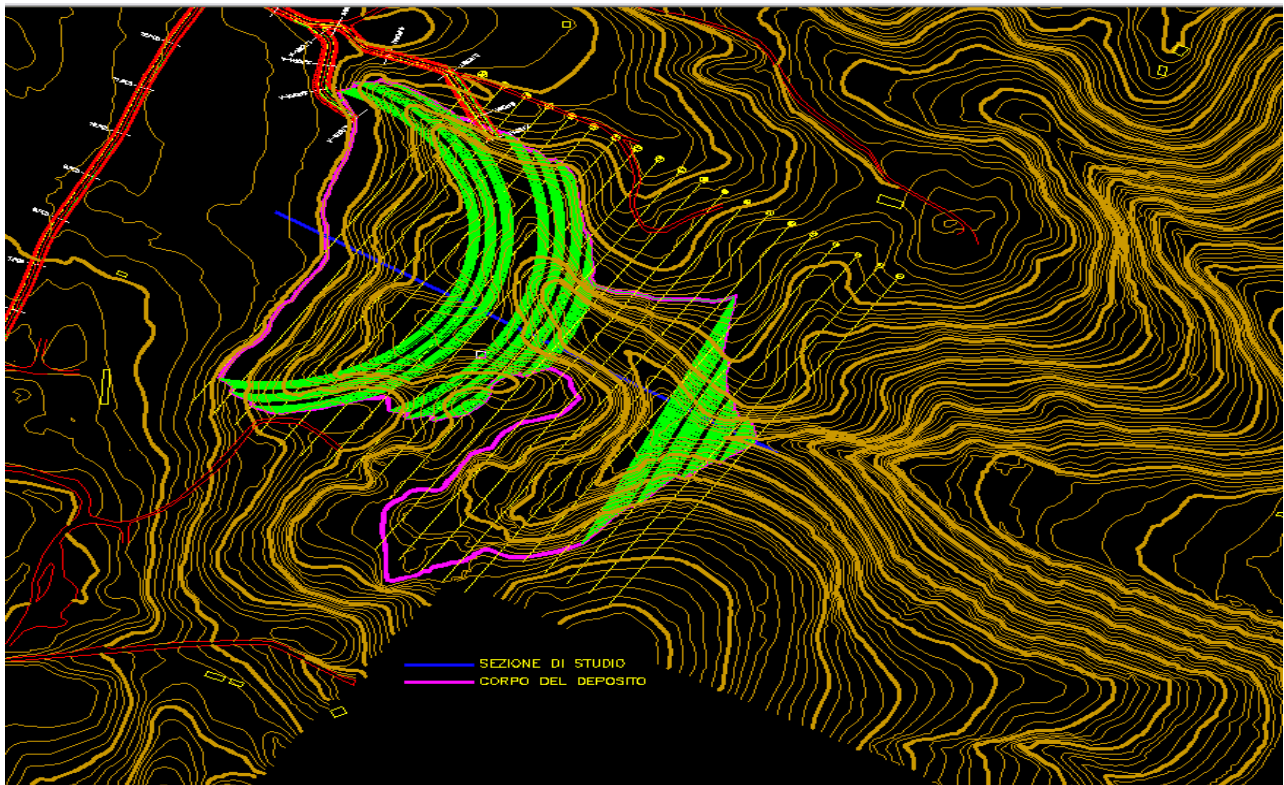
Planimetria del deposito "CRA1" con indicazione della sezione di calcolo
